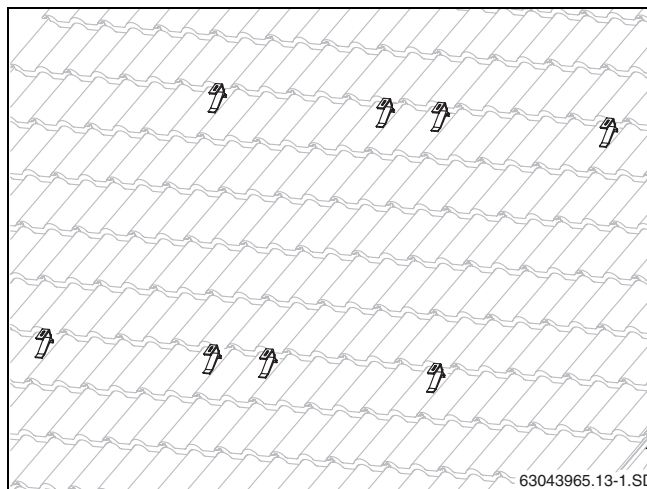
Крыша с установленными кровельными крюками для двух коллекторов
